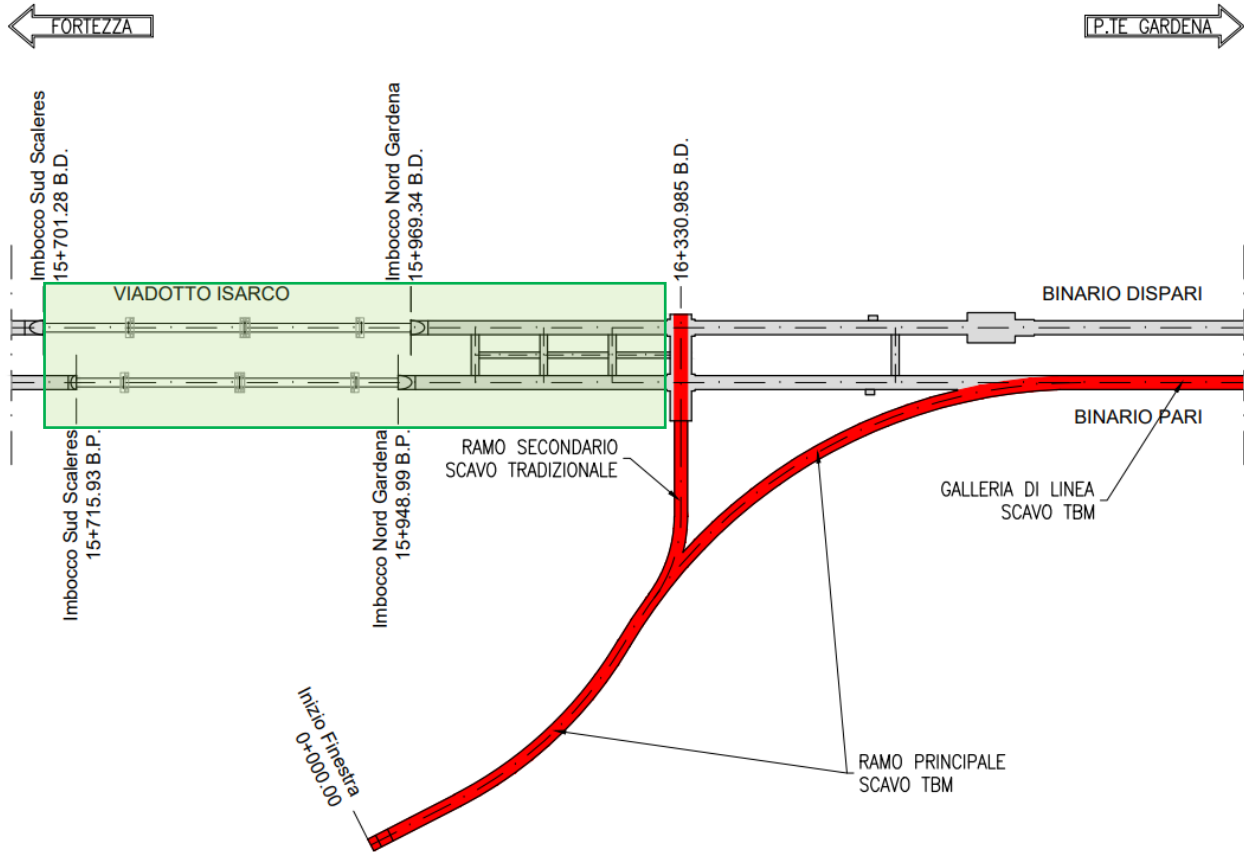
Planimetria localizzazione PES Ponte Isarco e Finestra Funes
